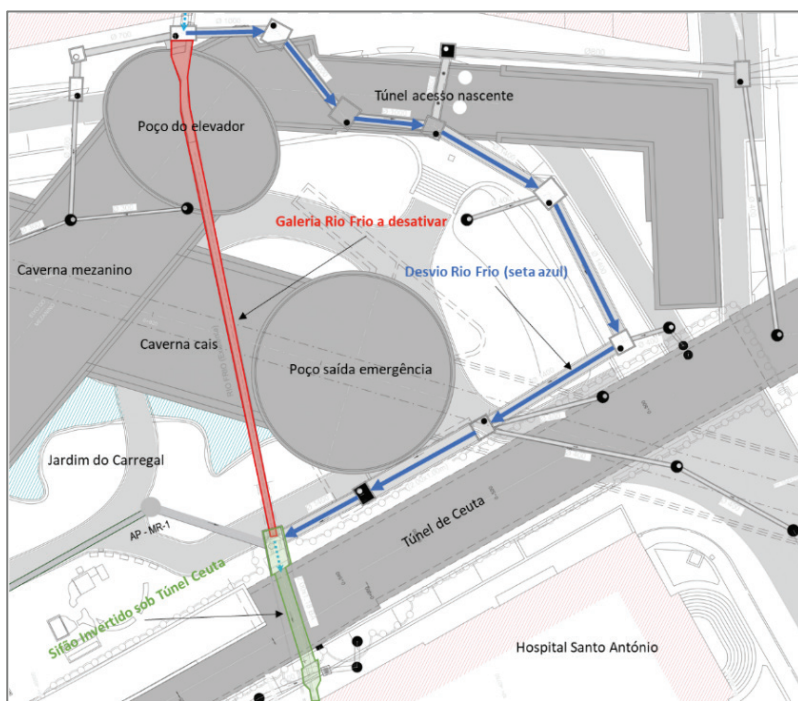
Planta do desvio Rio Frio (Pereira, 2023).
